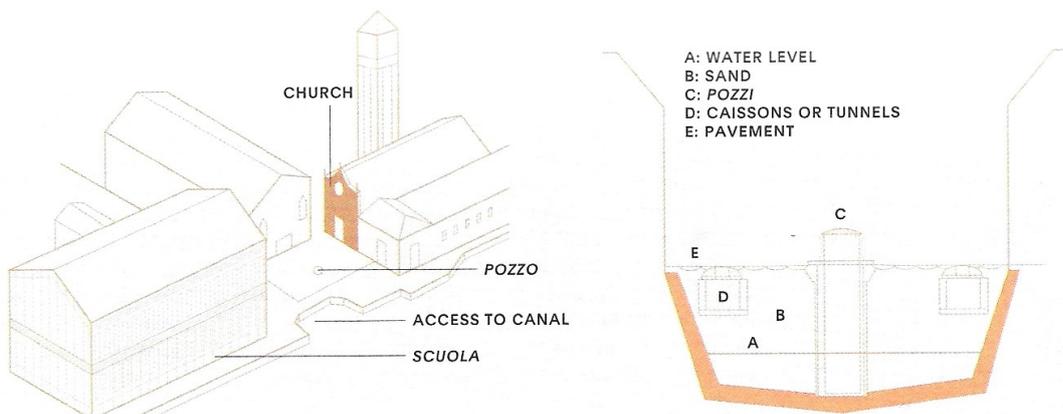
Plan type d'un campo et d'un puit. (LabaEPFL, p.93)
